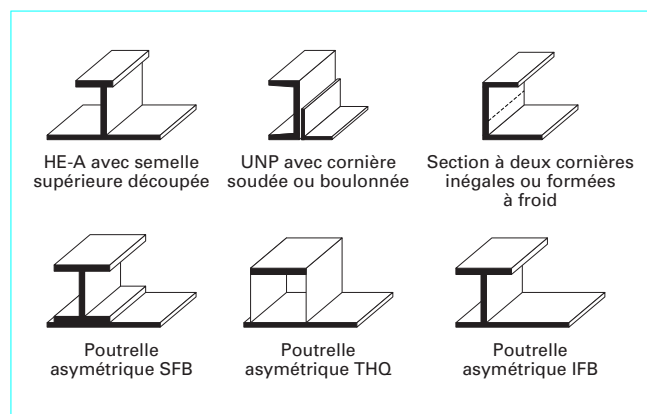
Plancher à poutrelles intégrées. Poutrelles de rives
